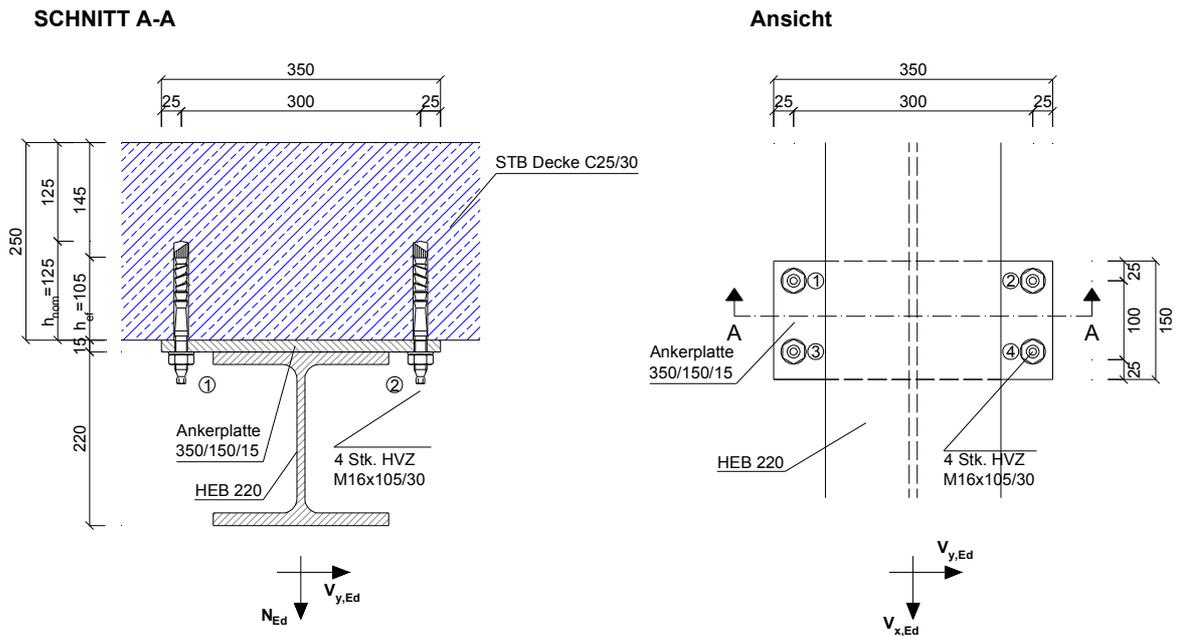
Anschlussdetail K1 Dübel Variante 1 (Maße in mm)
